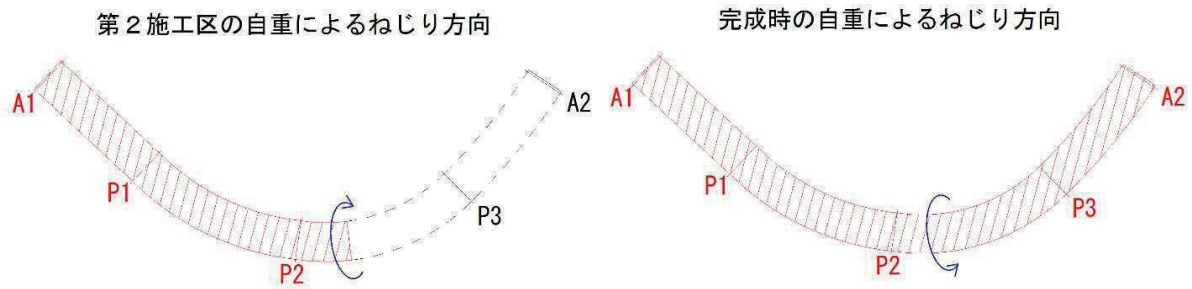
施工時と完成時のねじり方向（分割施工）
